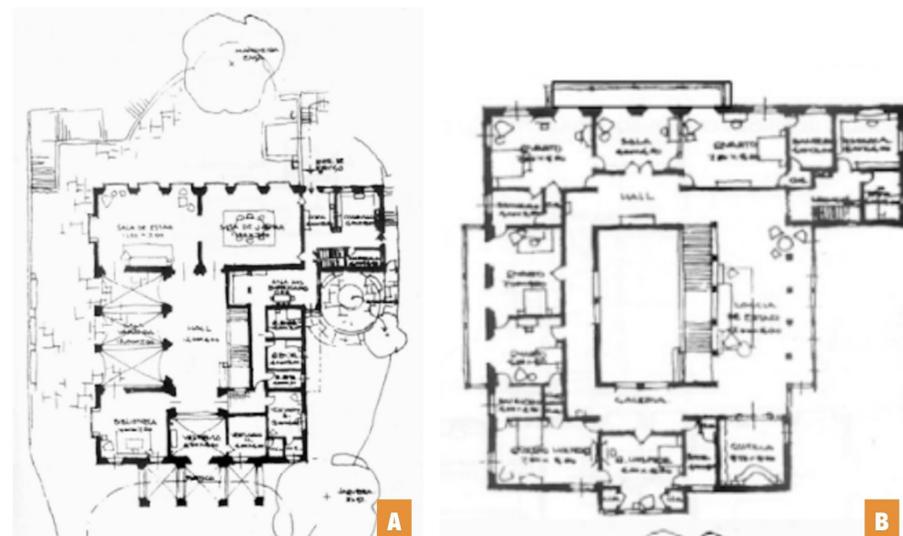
Planta Baixa Casa Fábio Carneiro de Mendonça,
